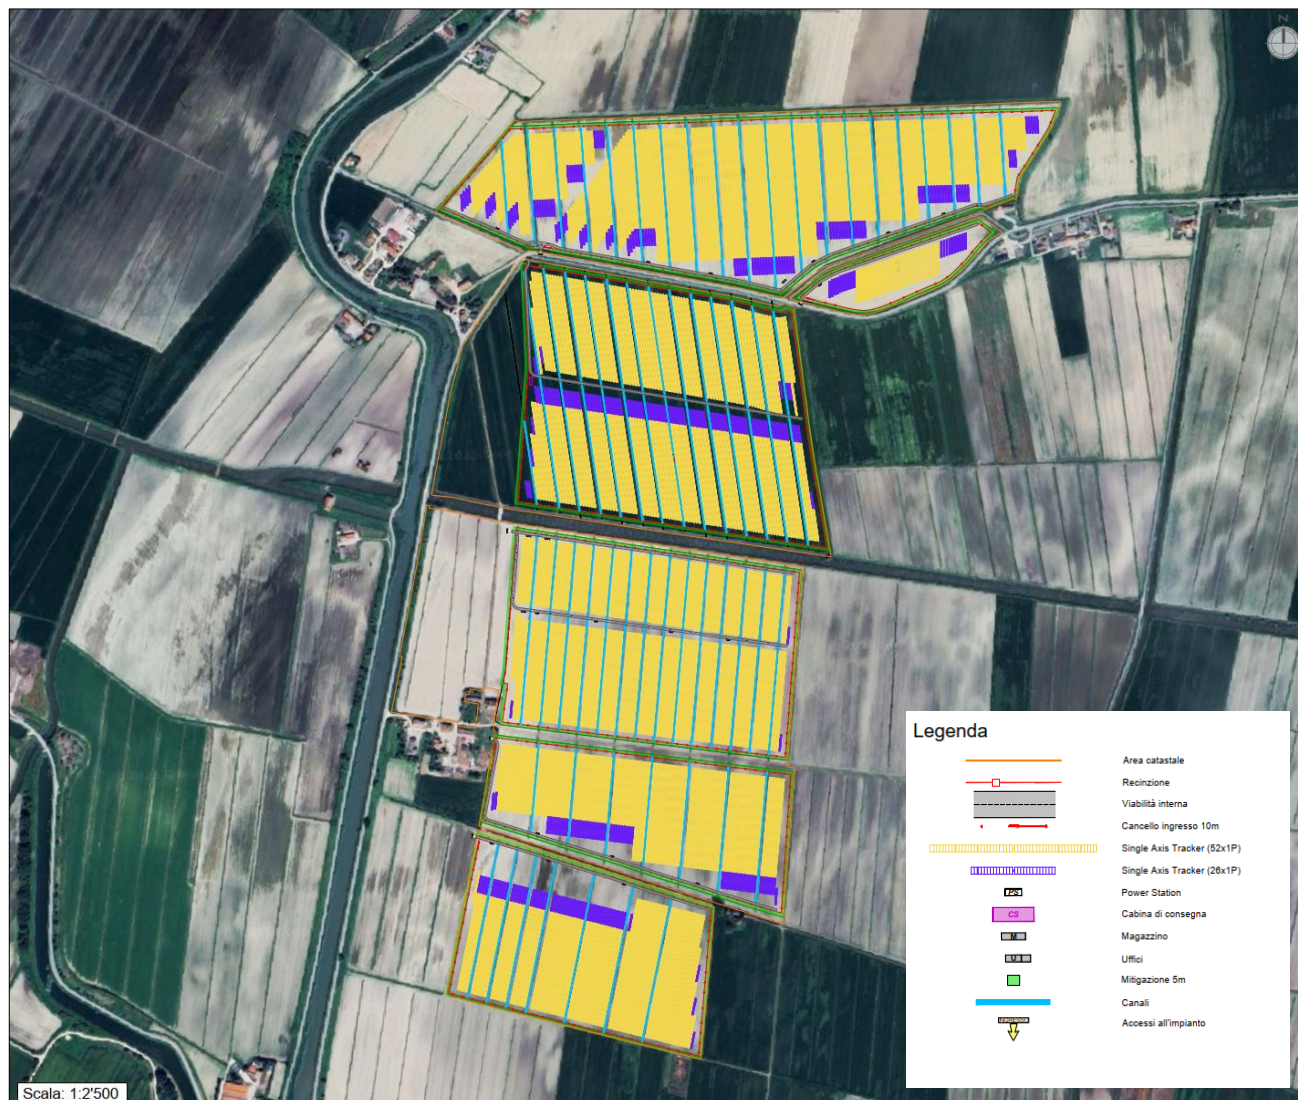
Layout di impianto (cfr E689_PG_1101_0_Layout di progetto).
